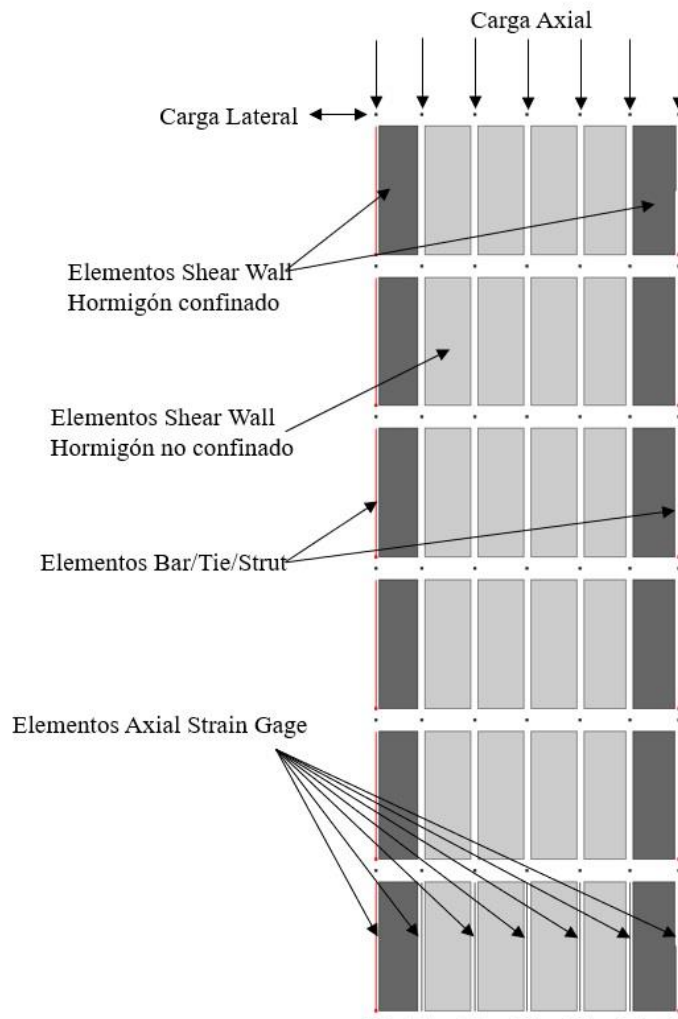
Muro RW2 [19] modelado en Perform 3D.
